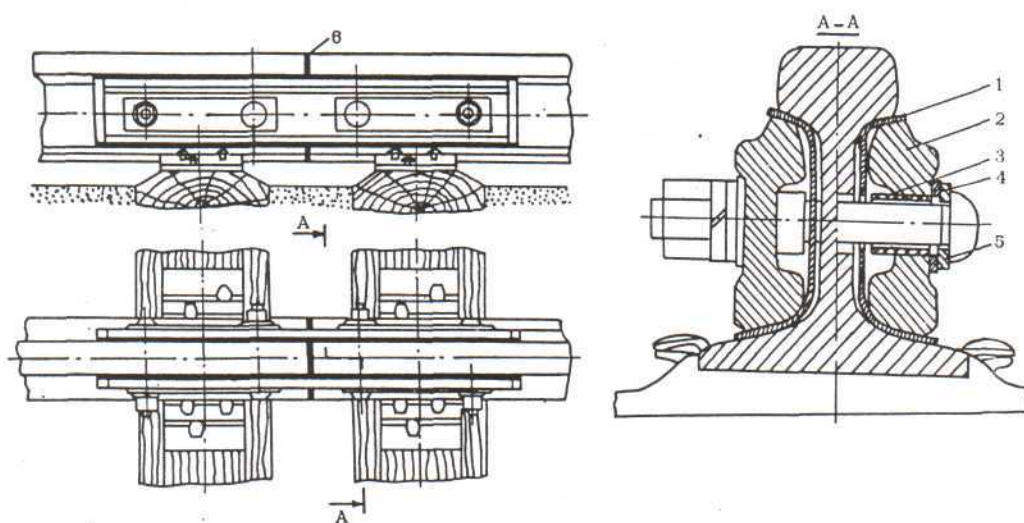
Изолирующий стык с двухголовыми металлическими накладками на деревянных шпалах: 1 - прокладка боковая, 2 - накладка, 3 - втулка, 4 - планка под болты, 5 - стопорная планка, 6 - прокладка стыковар
